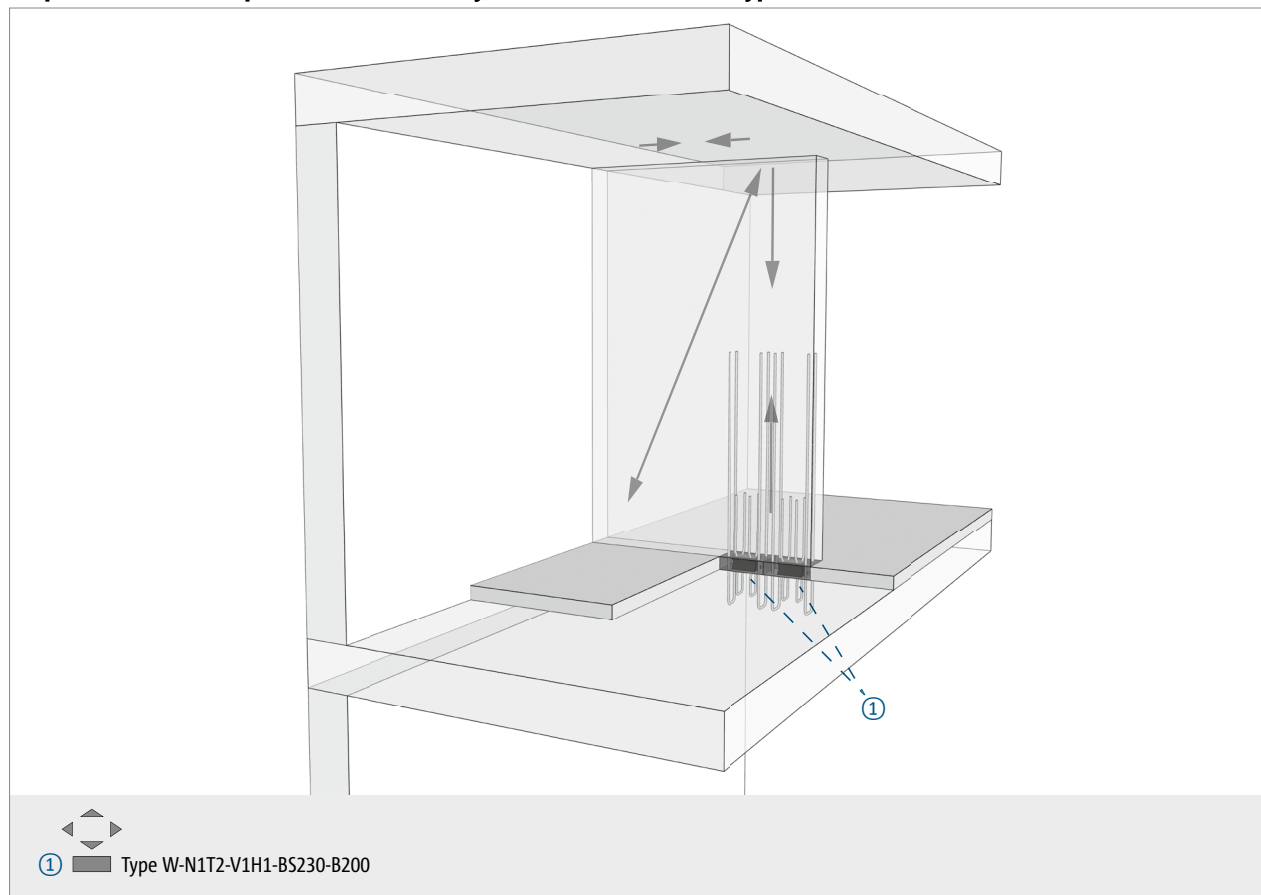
Mur de cage d'escalier sur la dalle, désolidarisé, sans appui
